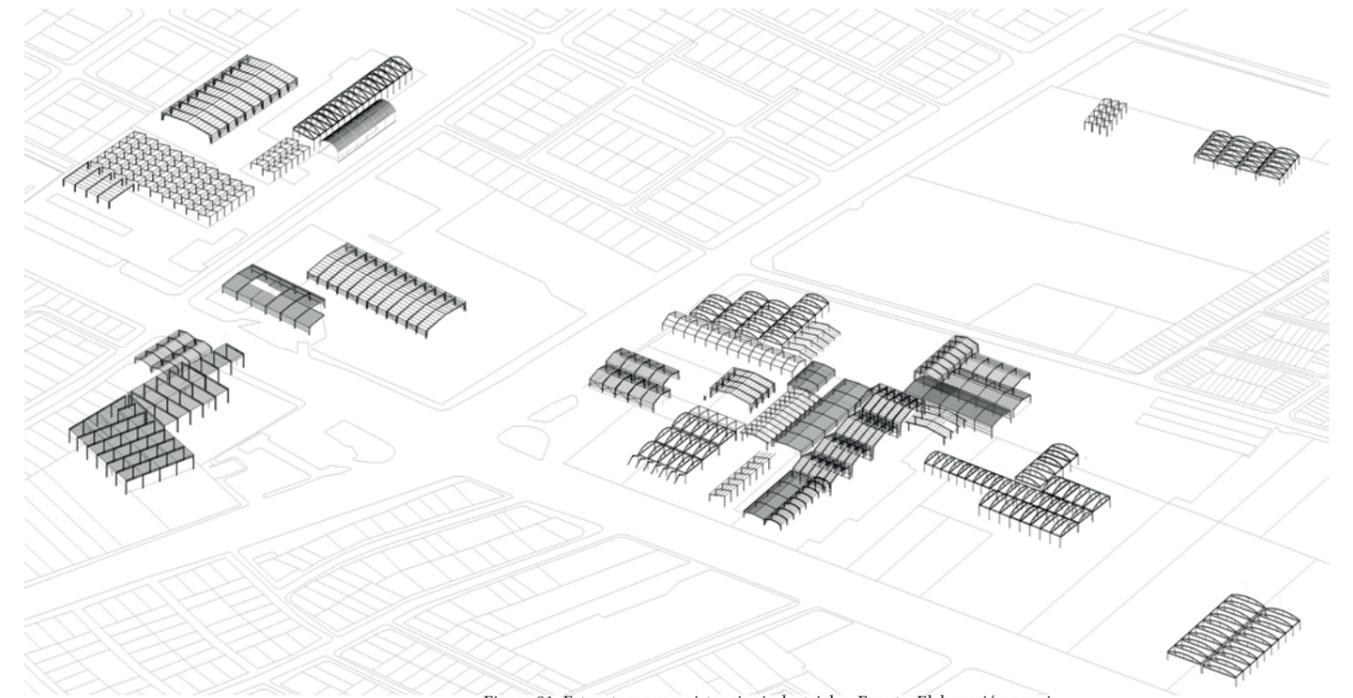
Estructuras preexistencias industriales. Fuente: Elaboración propia
